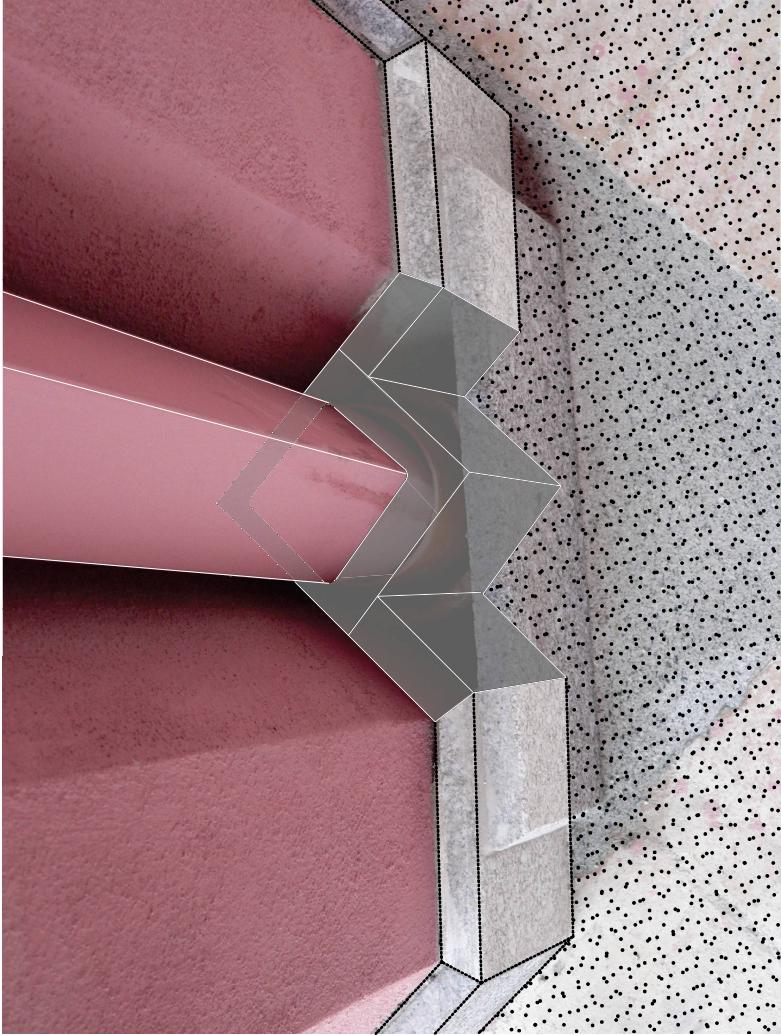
DETAIL - OPRAVY NAPoJENí SOKLŮ,
